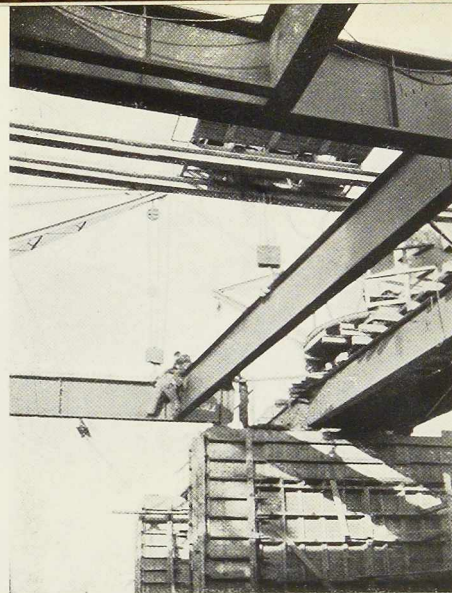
Montage d'une des poutres du tablier soudé.
